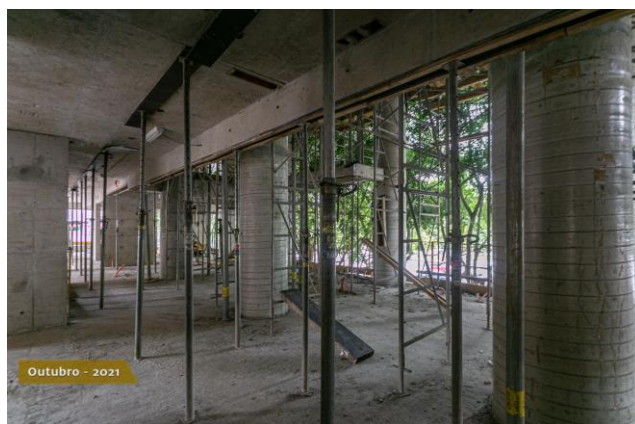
Pavimento com escoramento de vigas, pilares sem molde.
